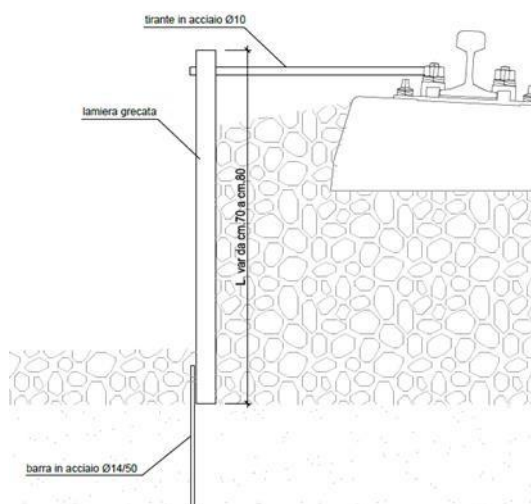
c – Dettaglio del contenimento del ballast
